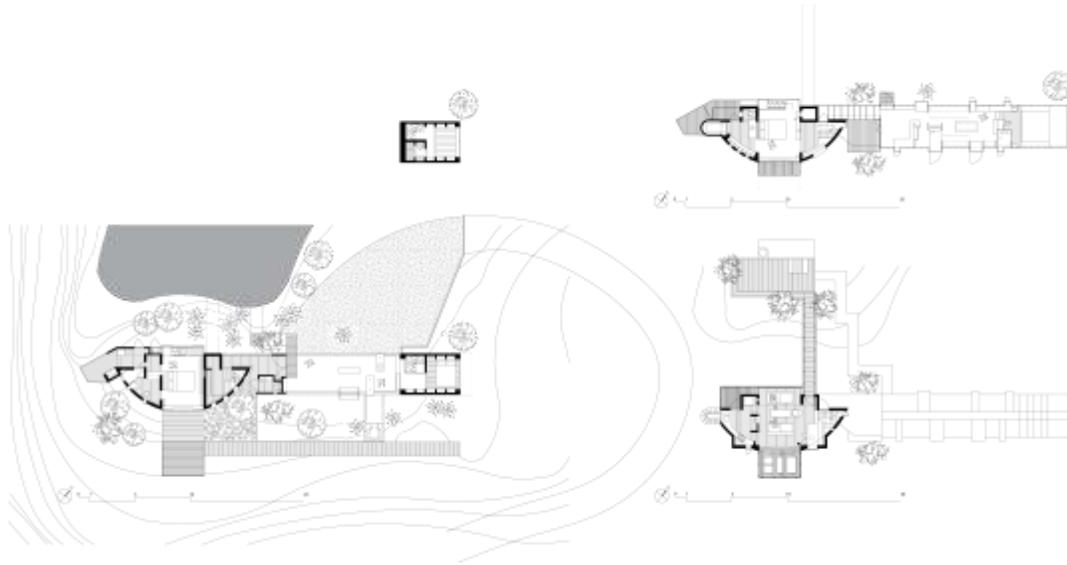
Planimetría Casa el Castillo. AutoCAD - Ilustrador
